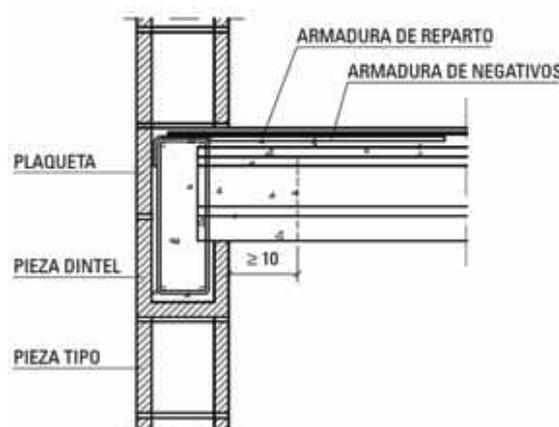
Apoyo de forjado sobre zuncho o cadena de hormigón armado.
